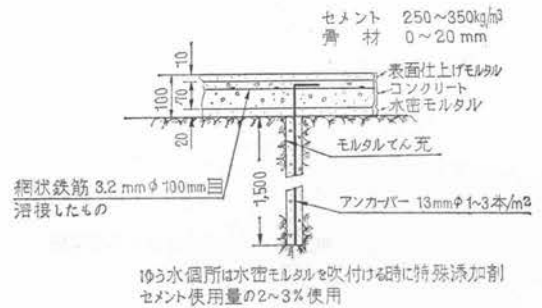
明り工事岩盤部コンクリート吹付けの一部断面図
